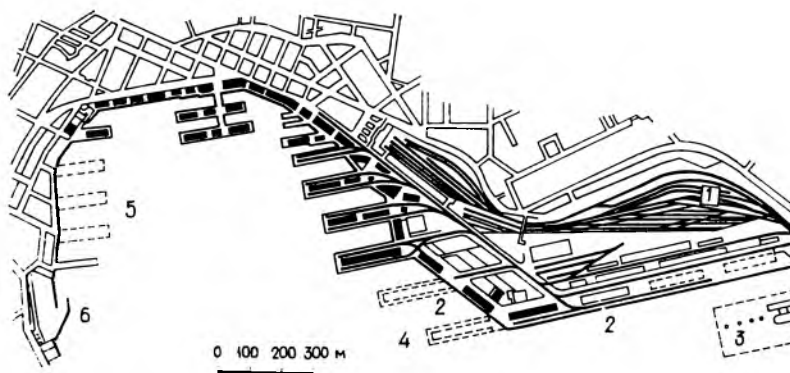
Порт Веллингтон (Новая Зеландия). План
